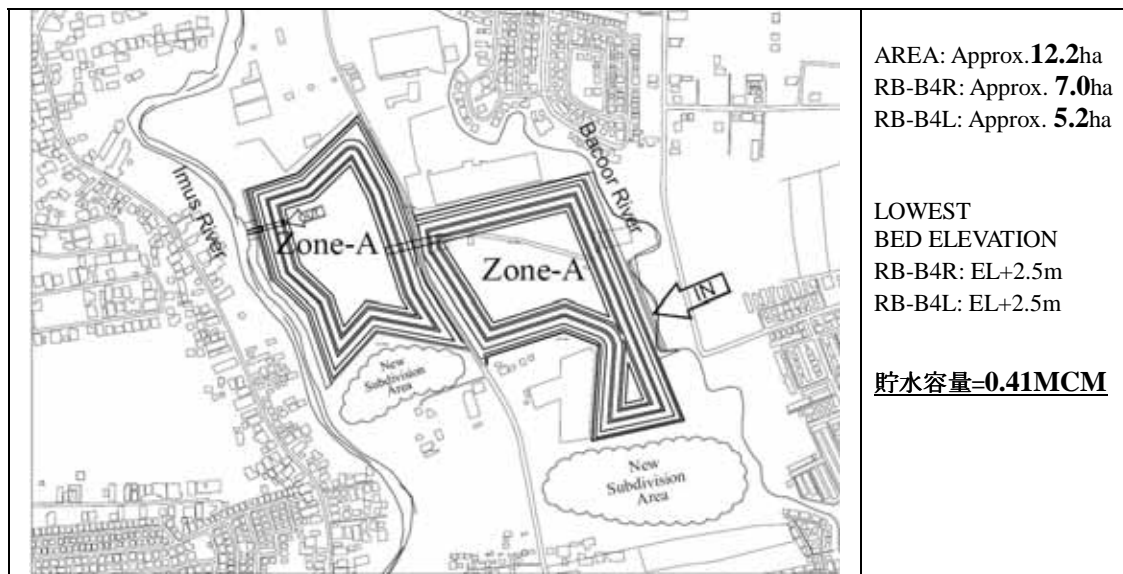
Bacoor 遊水地における利用可能な最大遊水地面積(12.2ha)案平面図
